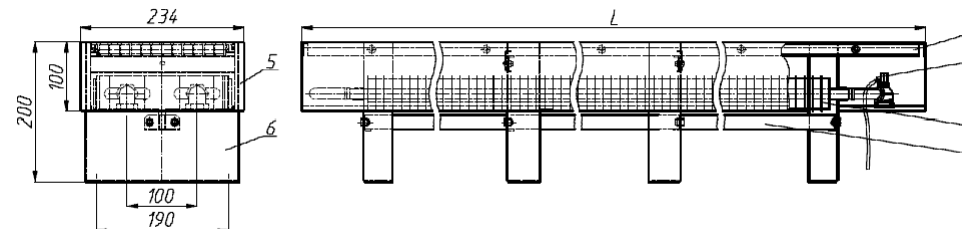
Конвектор напольный двоянный с нижним подключением – НКДН 05-10.050...300.
